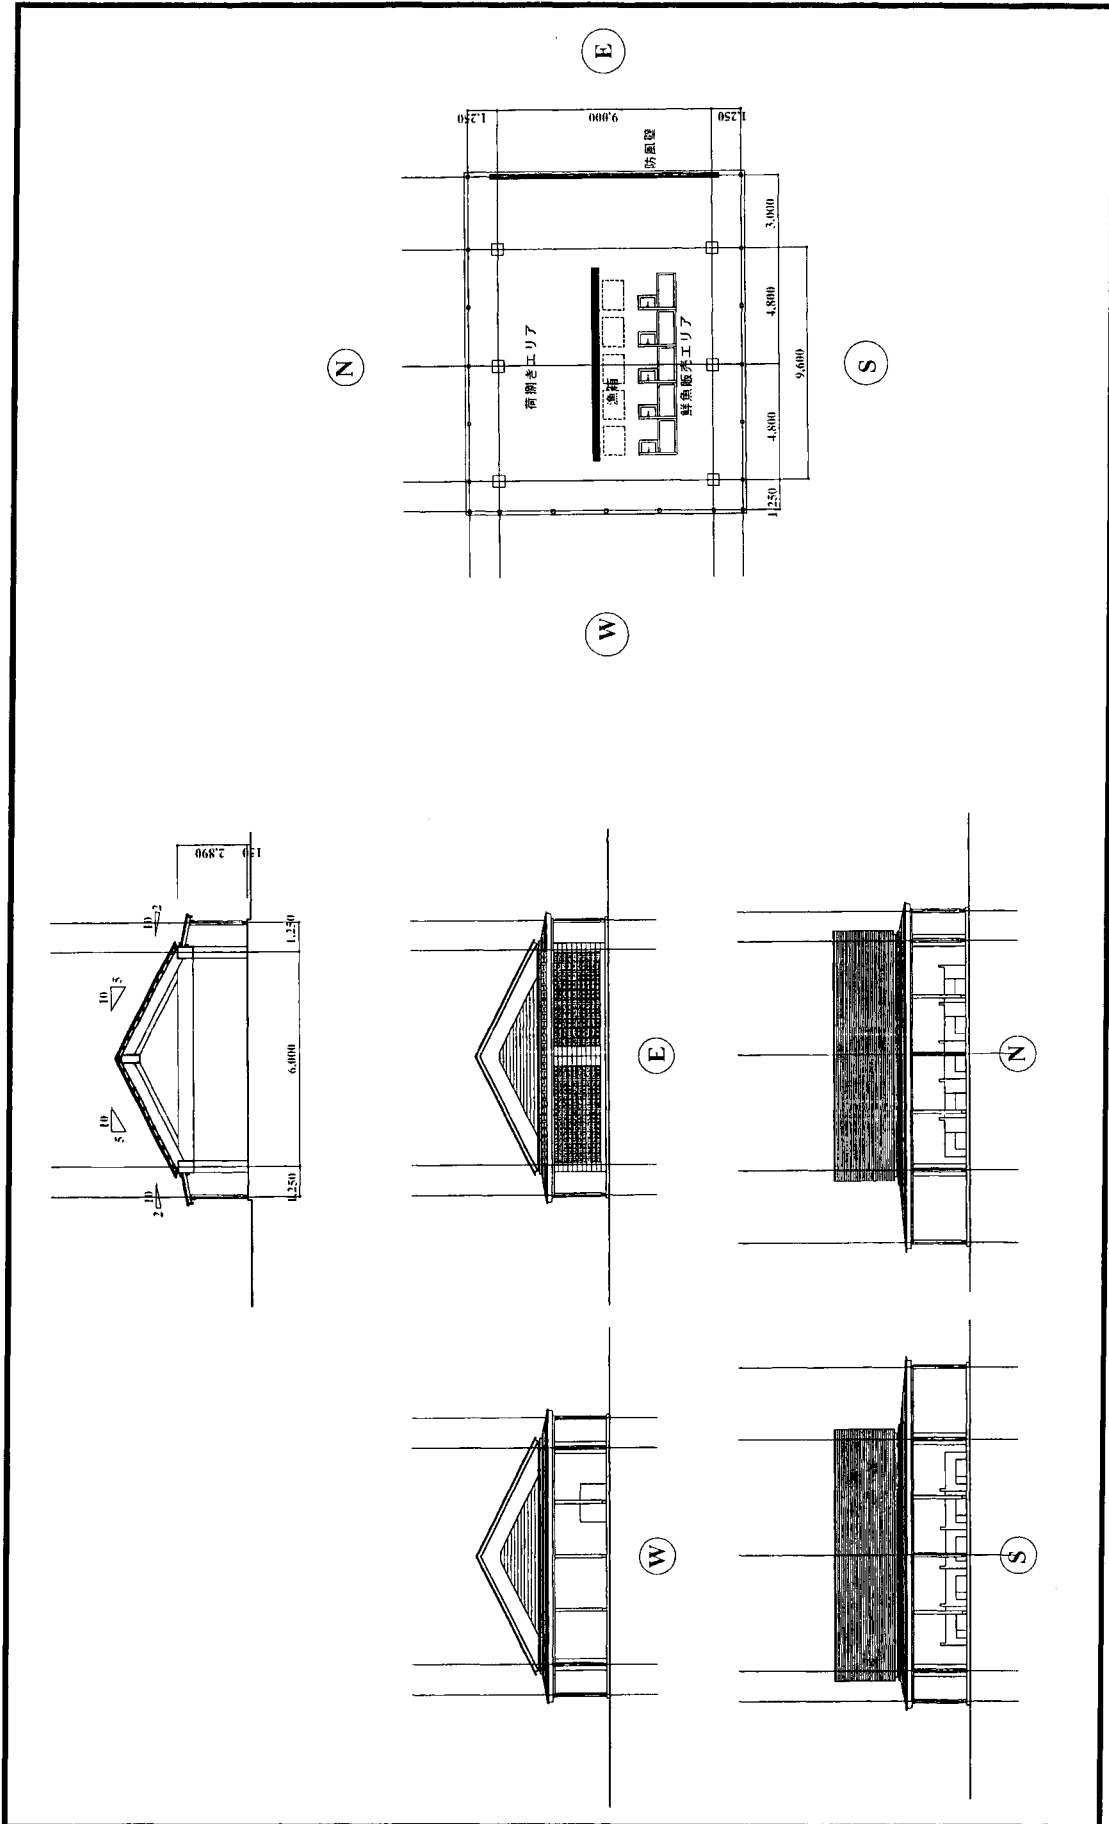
荷捌所・魚小売場平面・立面図
